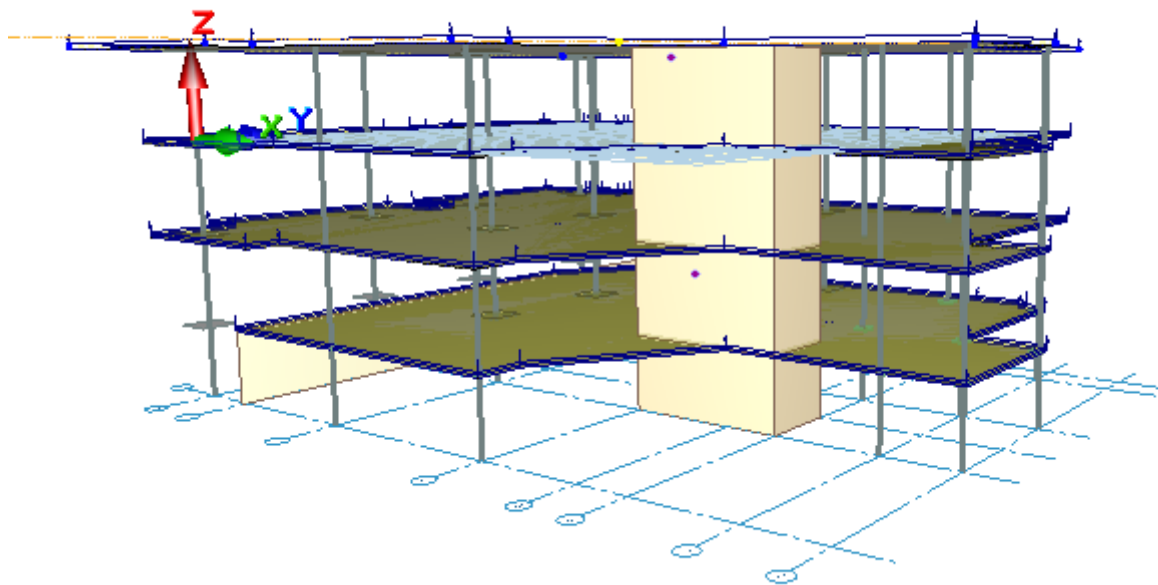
Расчетная схема перекрытия с колоннами, стенкой и диафрагмой жесткости.
